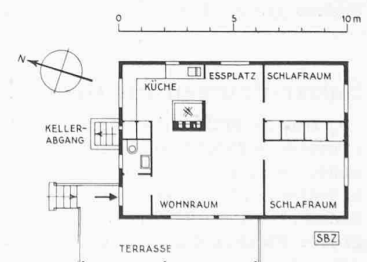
Holzhaus-Grundriss 1:300
